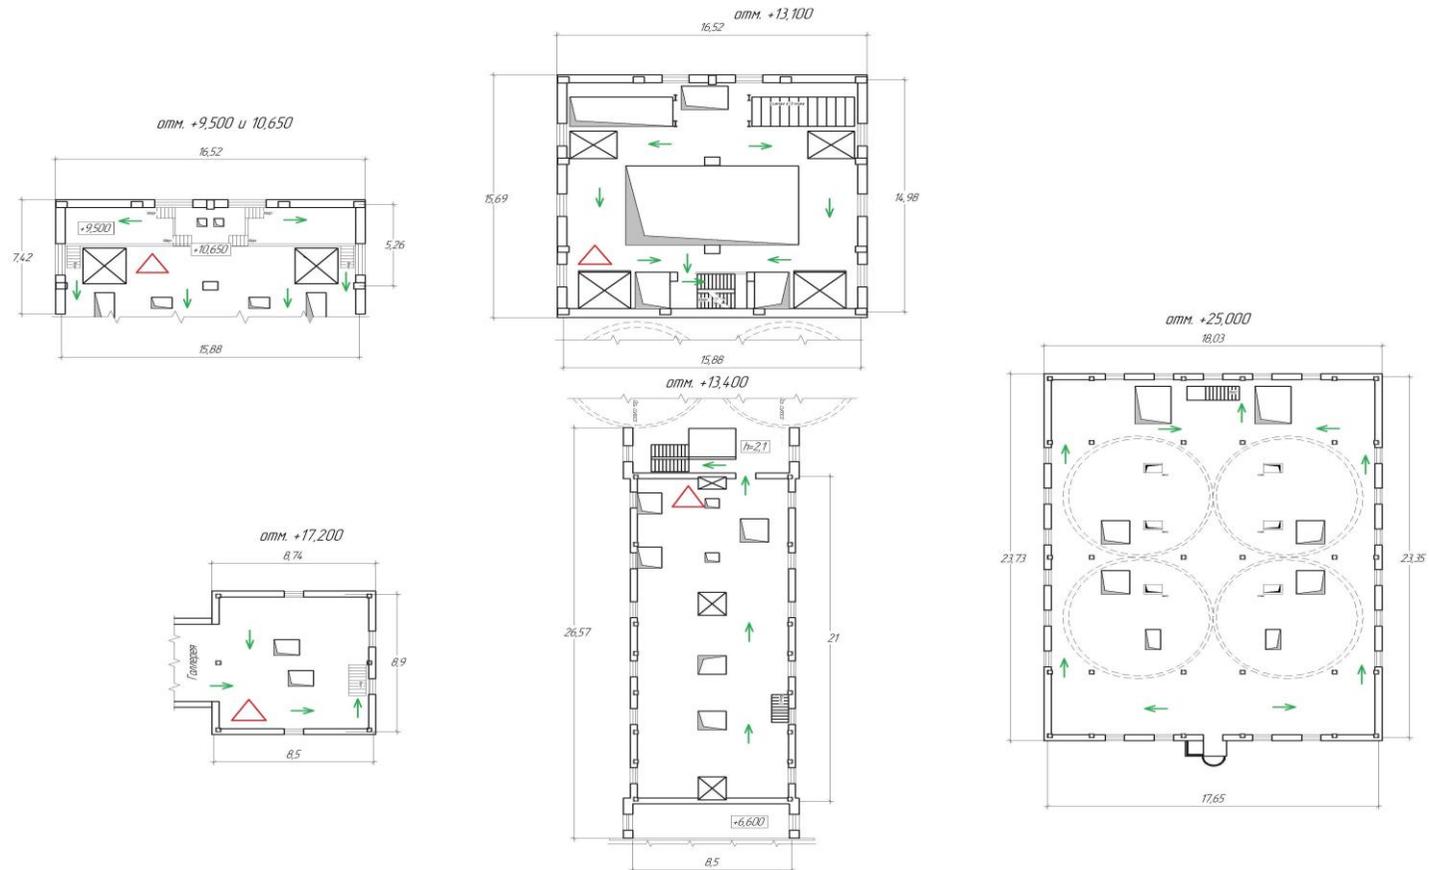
План-схема здания в-10-14-16 шихтовое отделение
